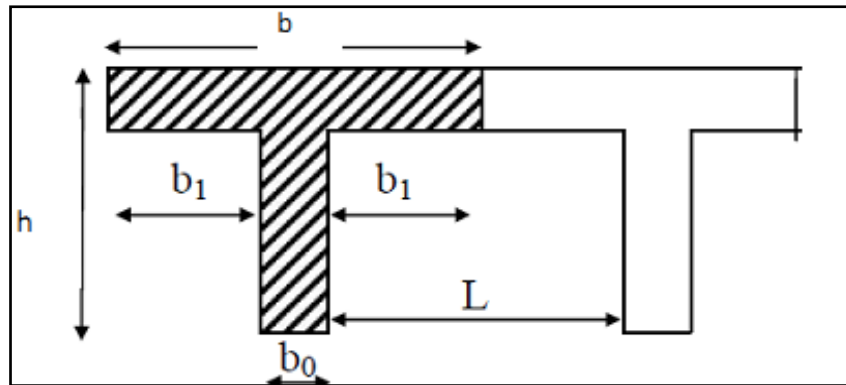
Section de la poutrelle après coulage de la dalle de compression
